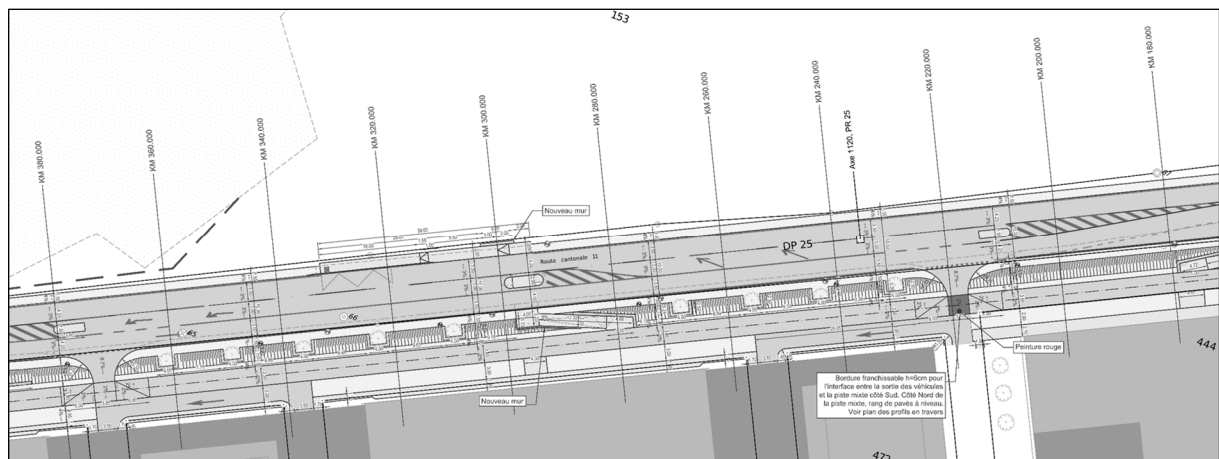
situation du projet de la partie hors localité pour la section du profil 180 au profil 380
